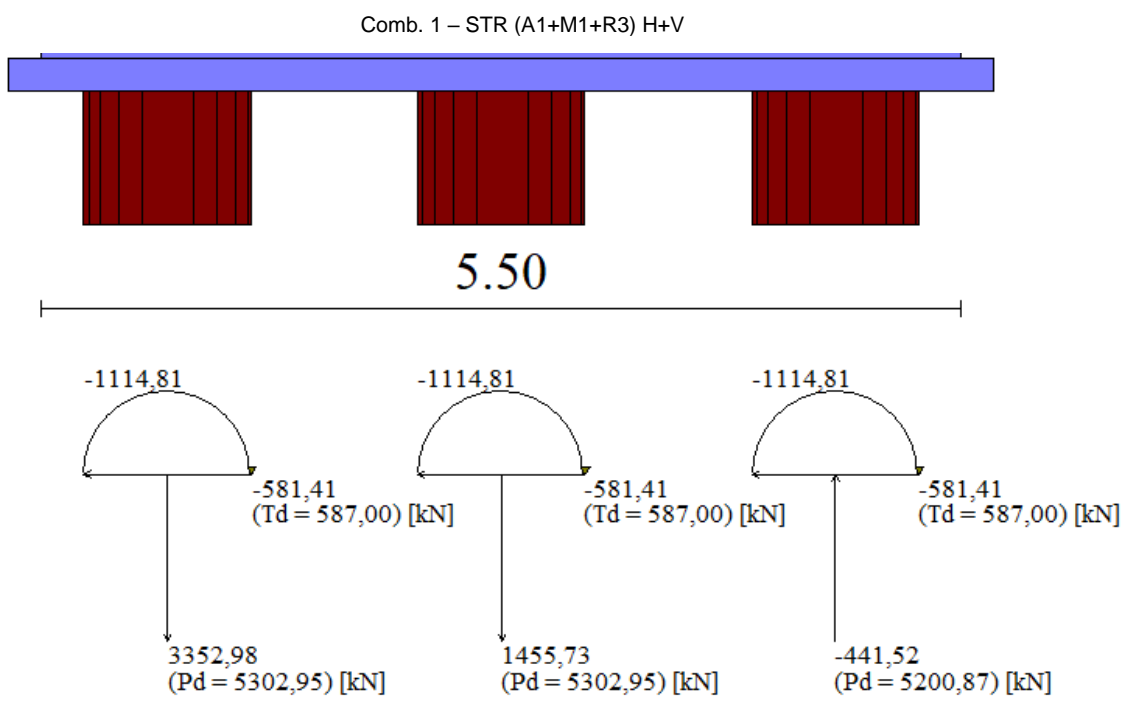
Scarichi in testa ai pali di fondazione del muro per la combinazione più sfavorevole (Comb.1)
